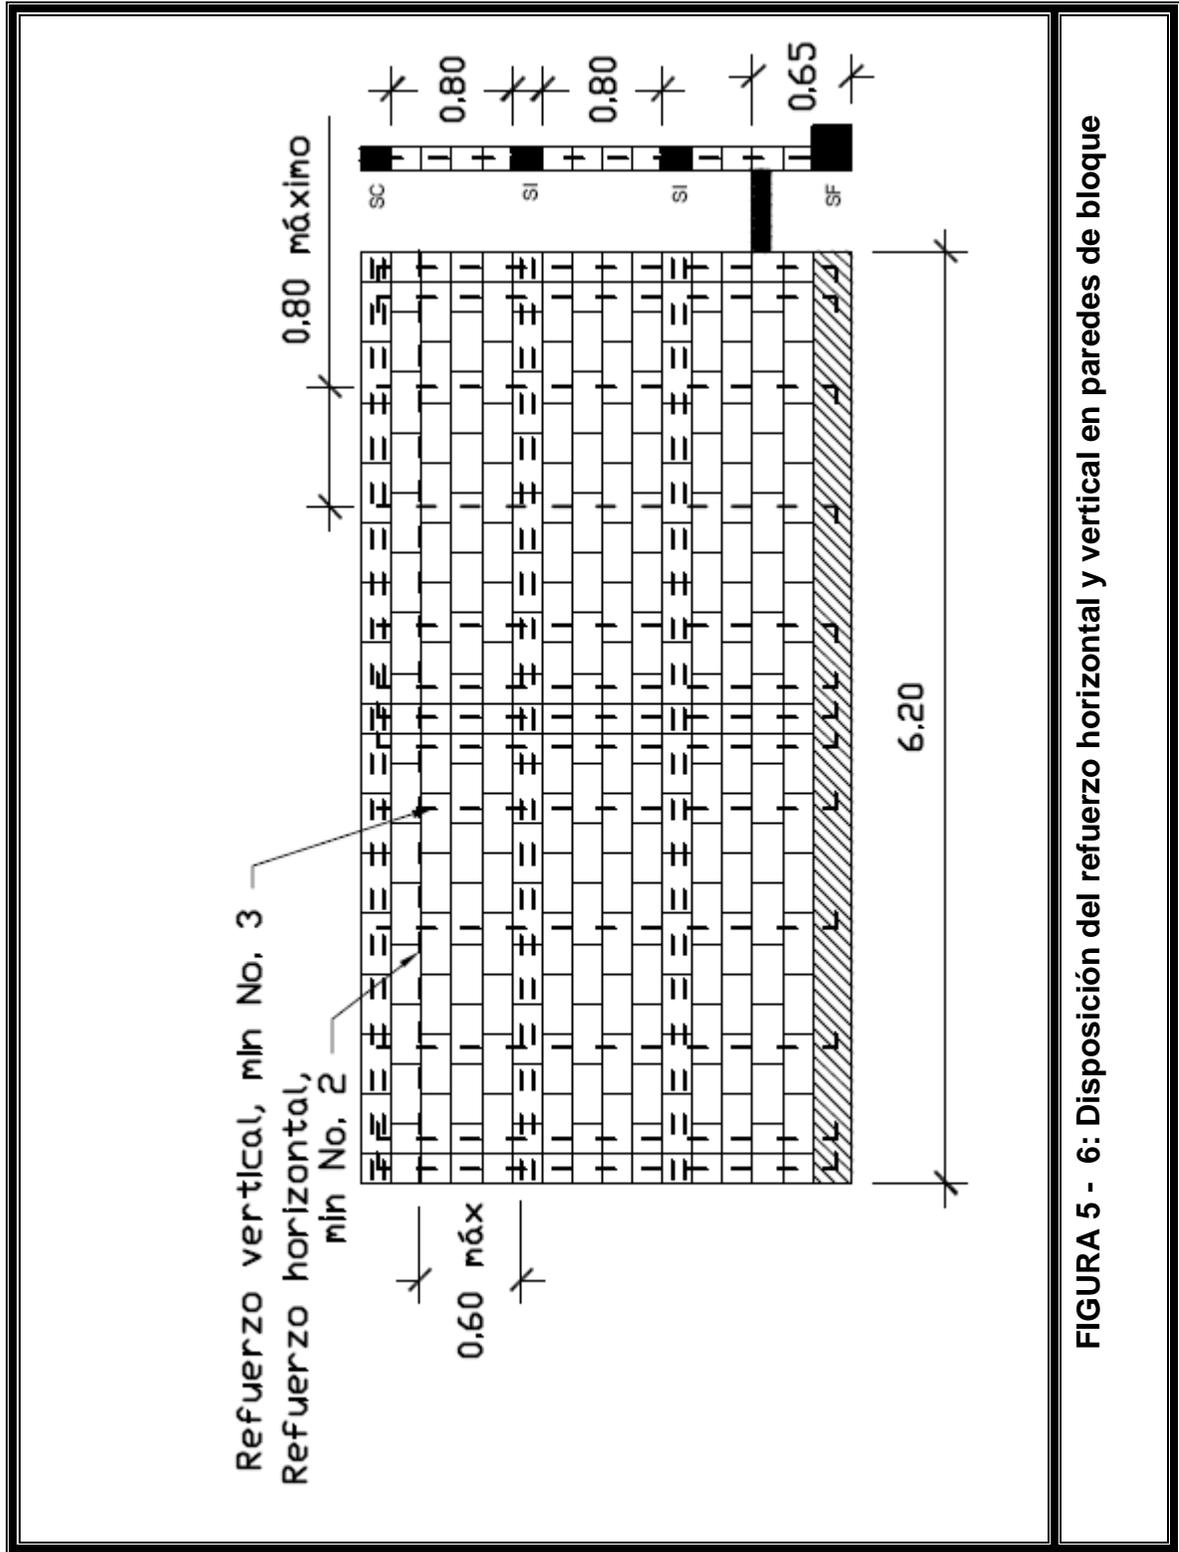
6: Disposición del refuerzo horizontal y vertical en paredes de bloque
